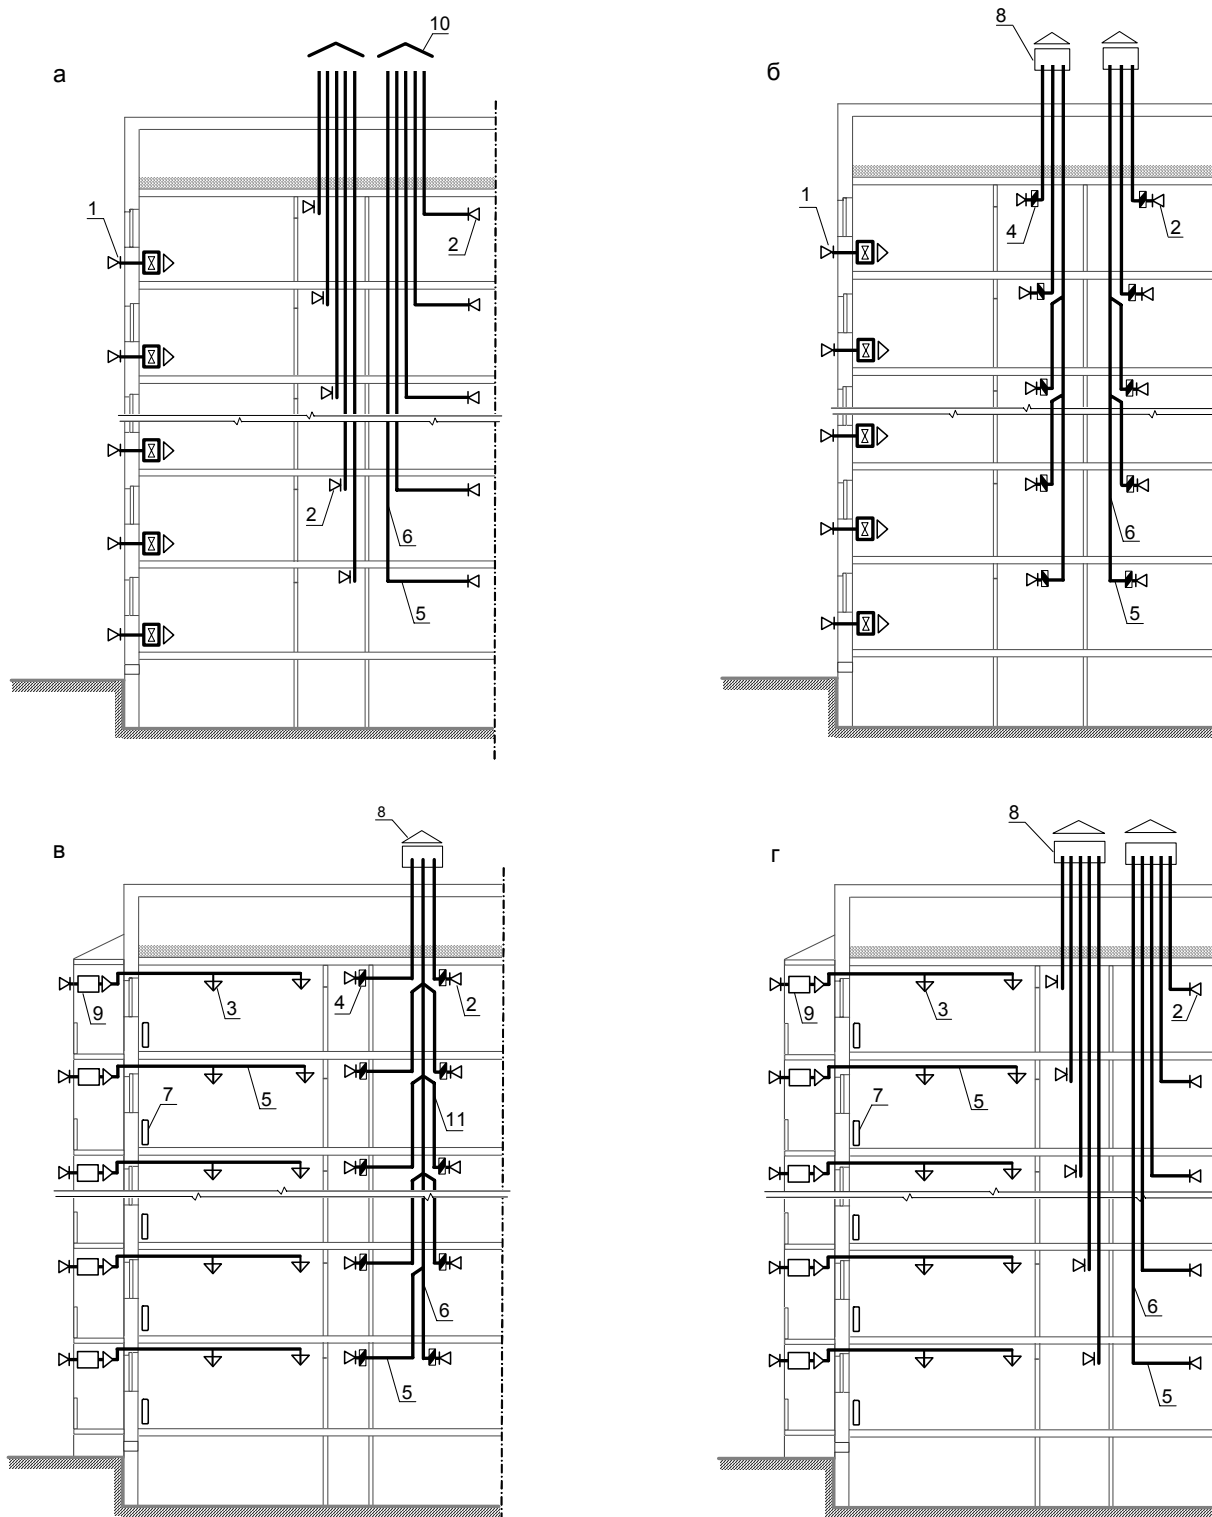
Схемы систем вентиляции жилых зданий с децентрализованным механическим притоком воздуха и удалением воздуха через вентиляционные каналы: а – с удалением воздуха через отдельные вентиляционные каналы; б – с удалением воздуха через вертикальные сборные и каналы-спутники; в, г – с поквартирными приточными вентиляционными системами: 1 – приточное устройство с встроенным вентилятором; 2 - вытяжная вентиляционная решетка; 3 – приточная вентиляционная решетка (воздухораспределитель); 4 - обратный клапан; 5 – горизонтальный вентиляционный канал (воздуховод); 6 – вертикальный вентиляционный канал; 8 – зонт; 9 – приточная вентиляционная установка с подогревом воздуха; 10 – зонт; 11 – канал-спутник
